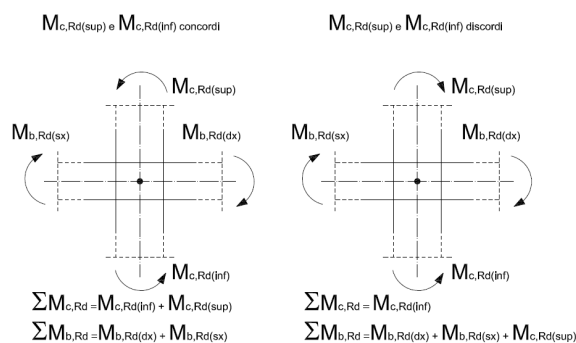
Progettazione in capacità dei pilastri
